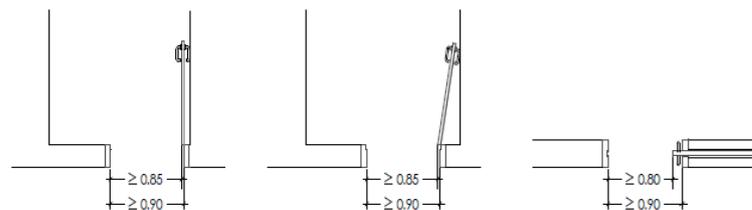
Decreto abril/2019. Anchura libre de puertas.
